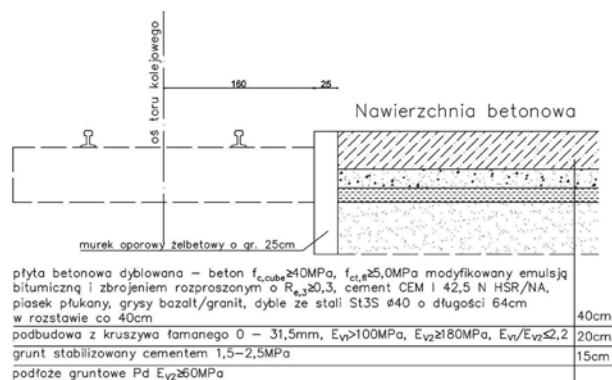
Schemat układu warstw konstrukcyjnych betonowej nawierzchni dyblowanej
